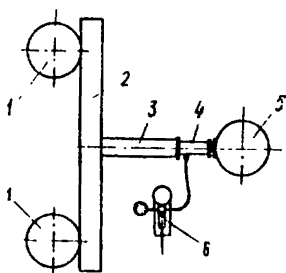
Схема комбинированного испытания на горизонтальную нагрузку одной свай:
